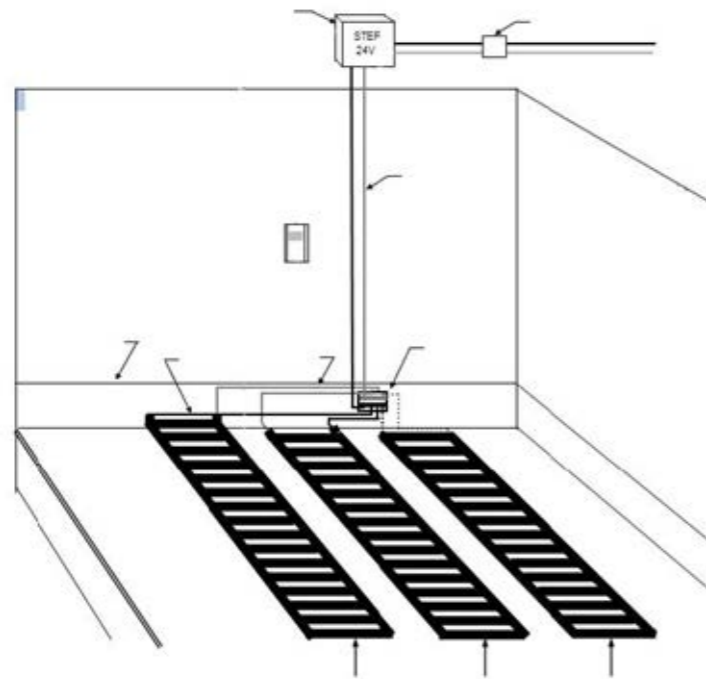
Schema impianto di riscaldamento a pavimento elettrico.
